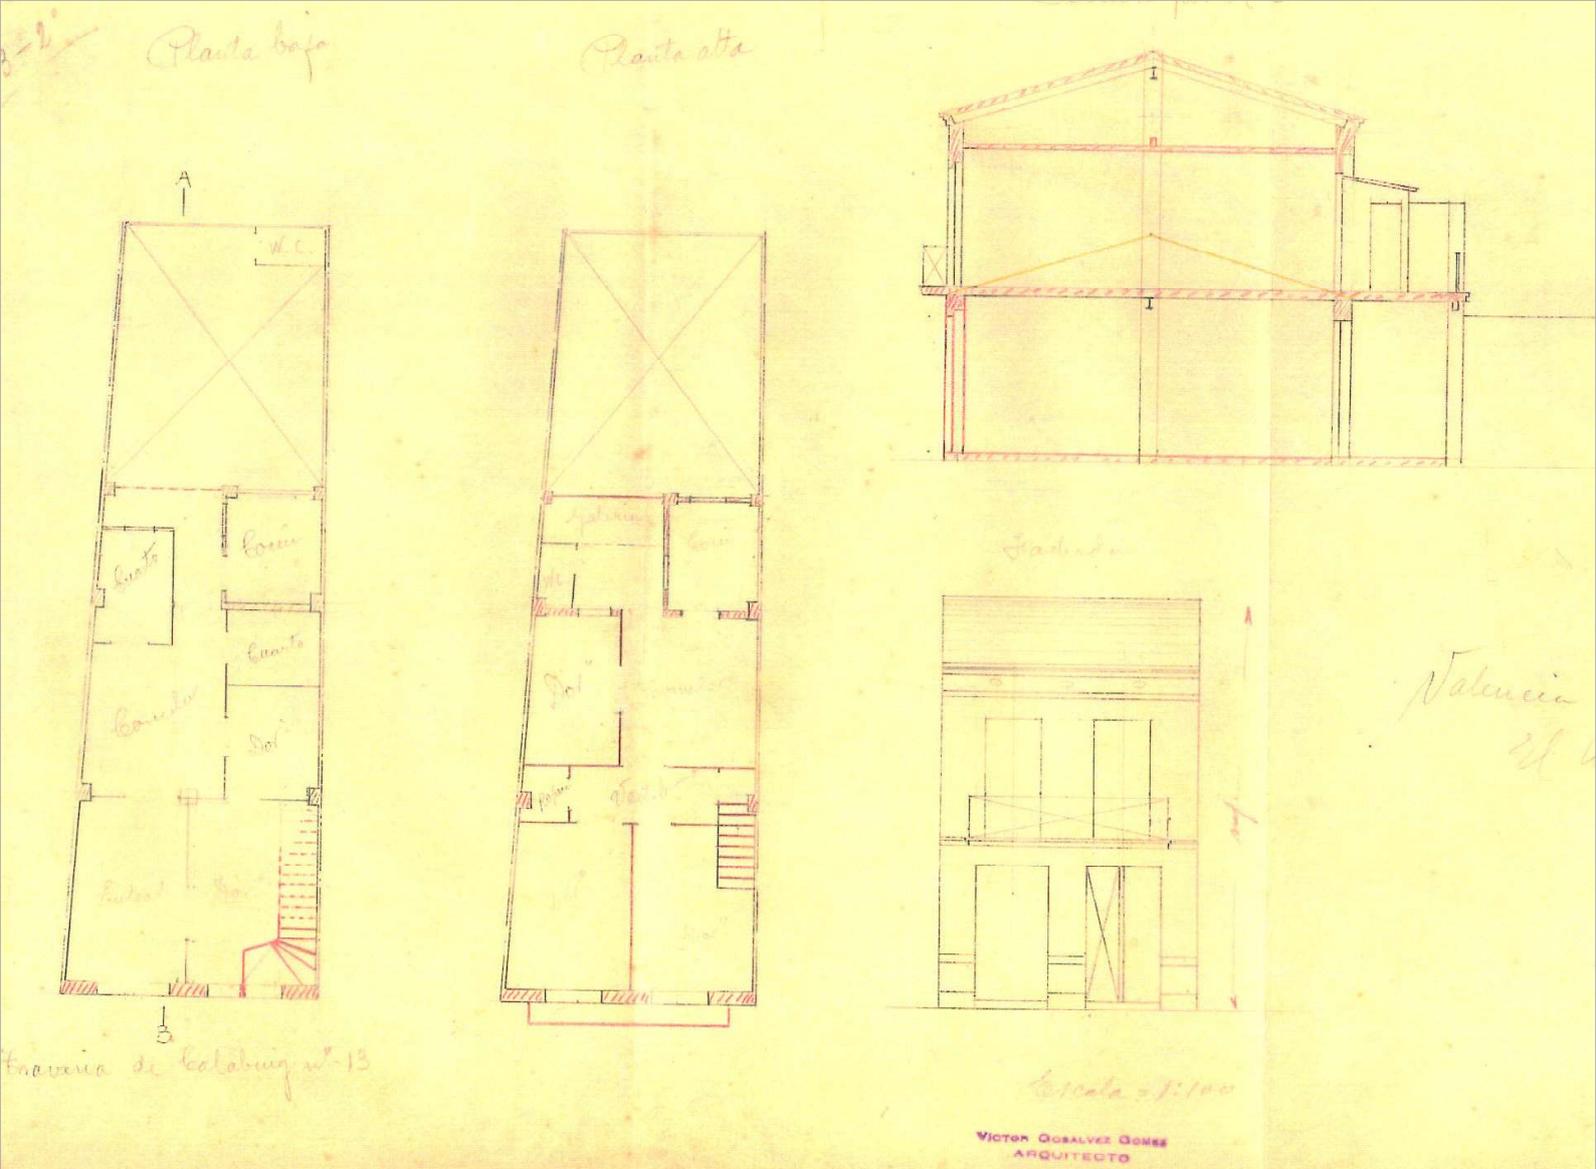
Proyecto de elevación de piso y reconstrucción de fachada en Travesía de Calabuig (1936). (Fondo Sandro Pons Romani)
